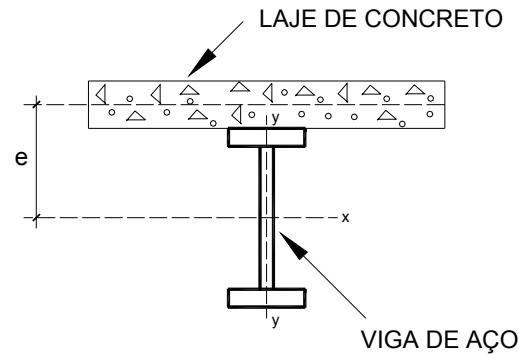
Visualização da excentricidade entre a laje e a viga
